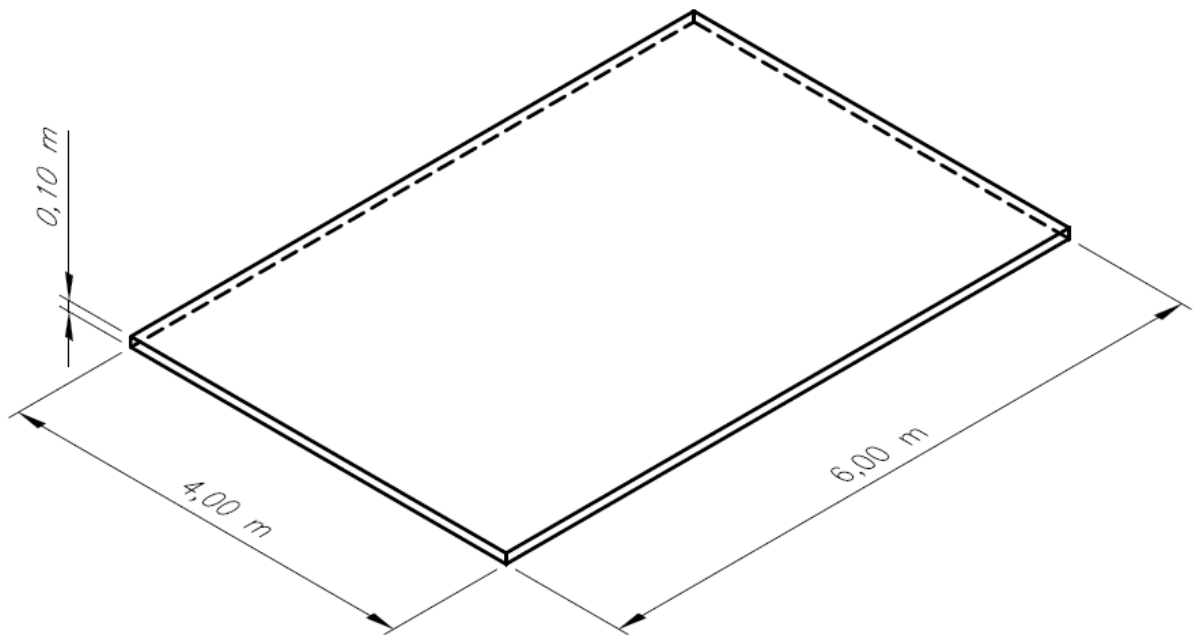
laje 2 - dimensões 4,00 x 6,00 x 0,10 m
